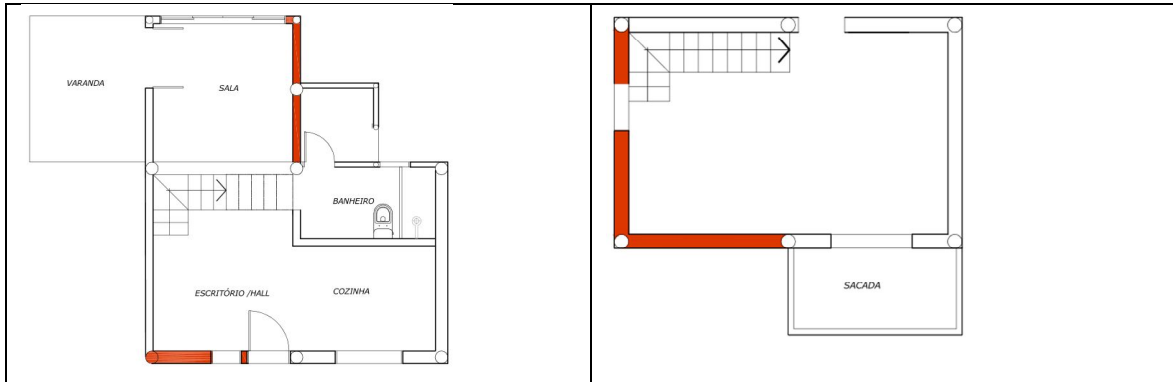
Plantas baixas do primeiro e do segundo pavimentos. Em destaque (cor) as paredes de taipa de mão).
